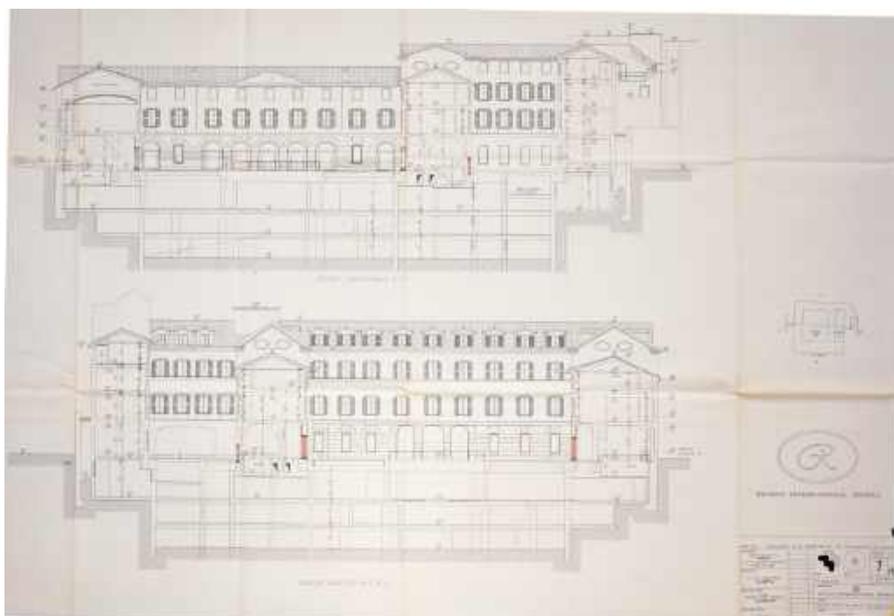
Sezione est, sezione ovest, progetto di restauro e riuso; tavola su carta
